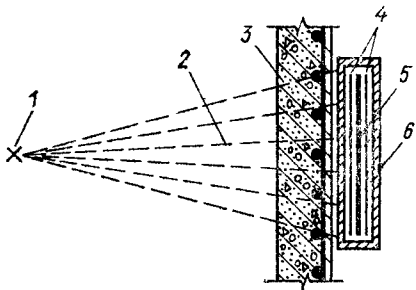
Схема просвечивания ионизирующими излучениями железобетонной конструкции
